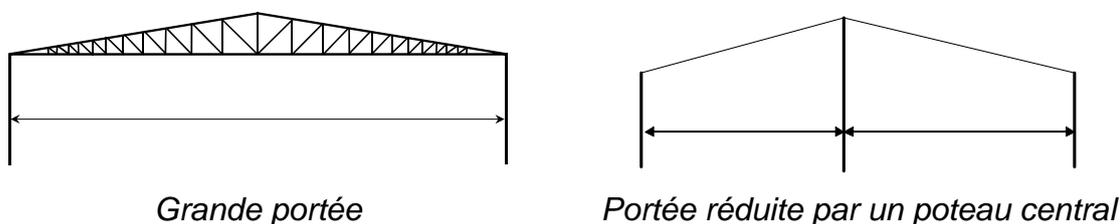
Schéma relatif à la portée des poutres fermières (Source : INERIS)
